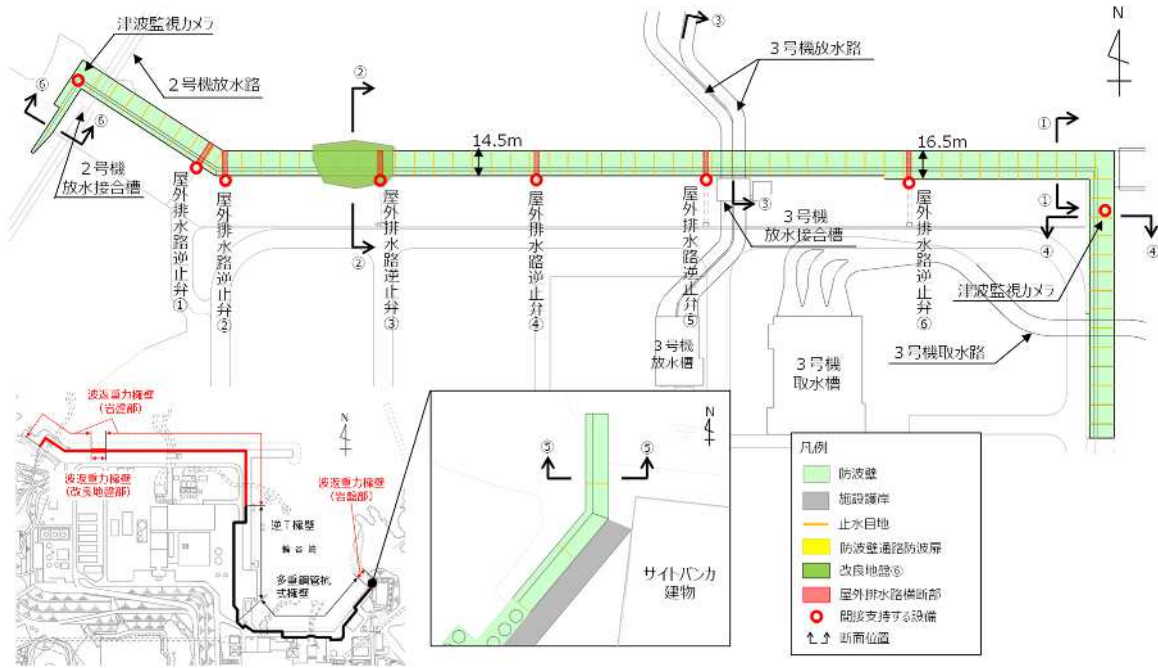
防波壁（波返重力擁壁）平面配置図
